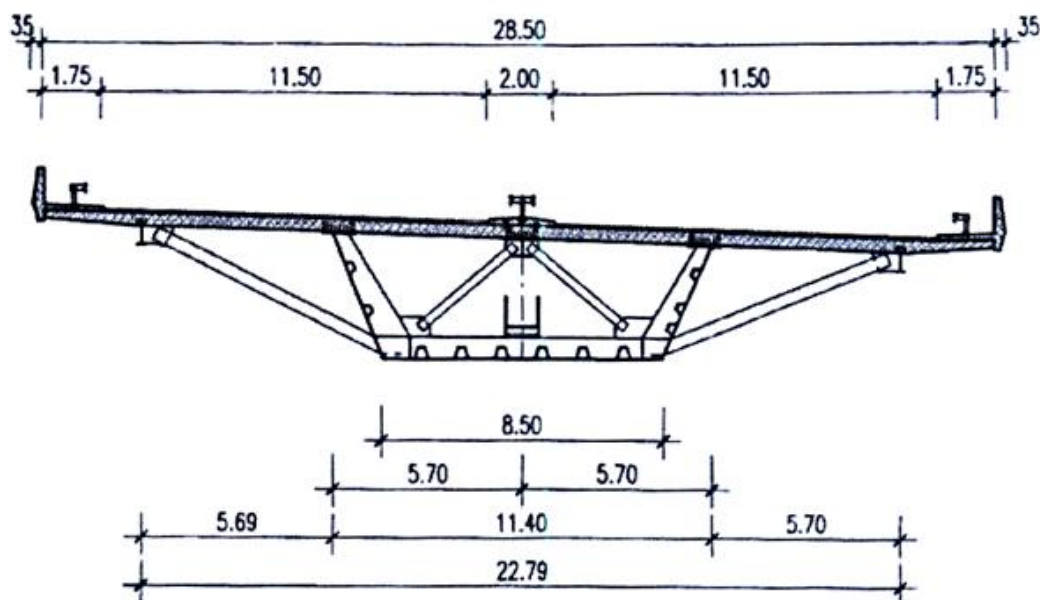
Поперечные сечения автодорожного моста с корытообразной стальной балкой, объединенной с железобетонной плитой [16]
